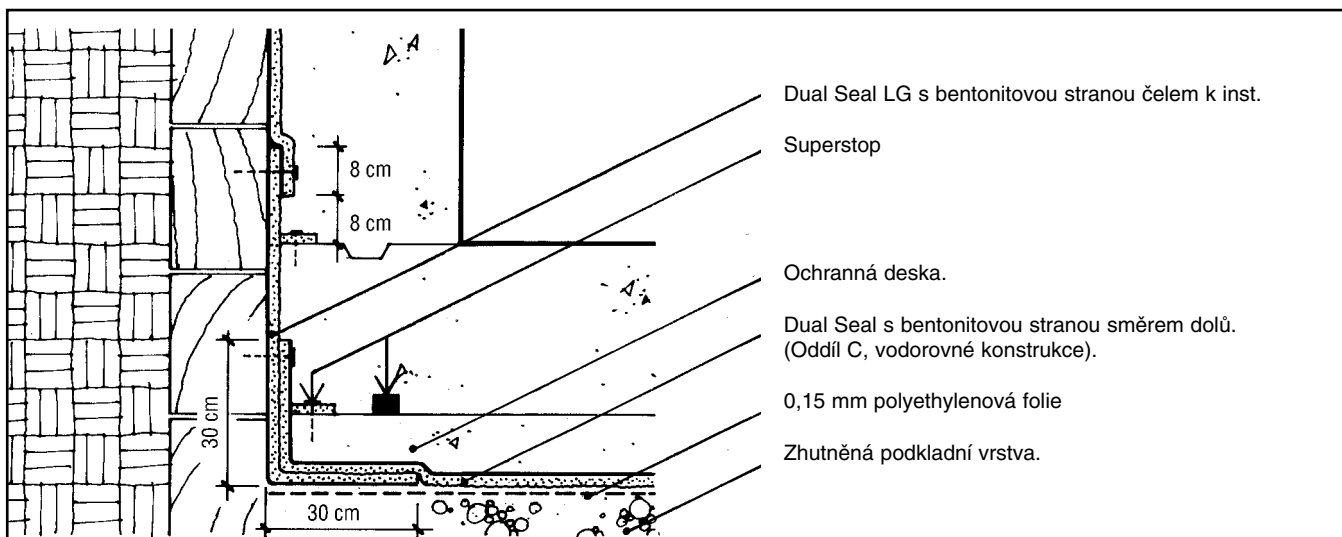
Vyrovnávací spoj - půdorysný pohled.
